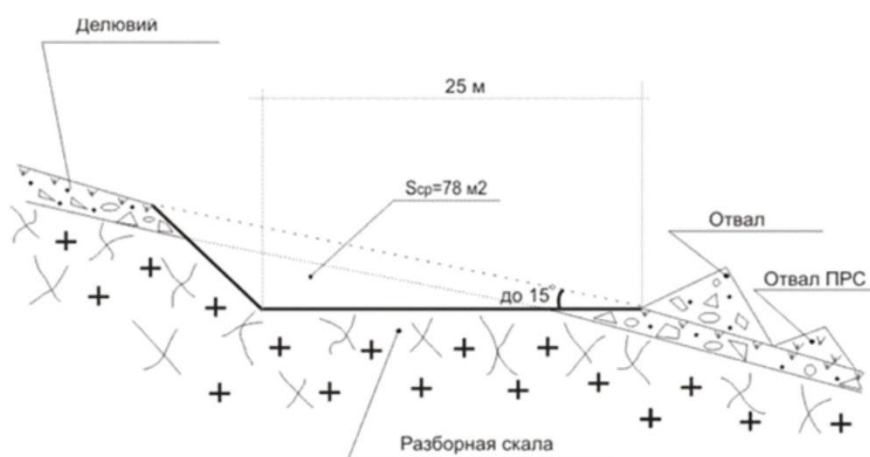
Схема поперечного сечения выемки под буровую площадку
